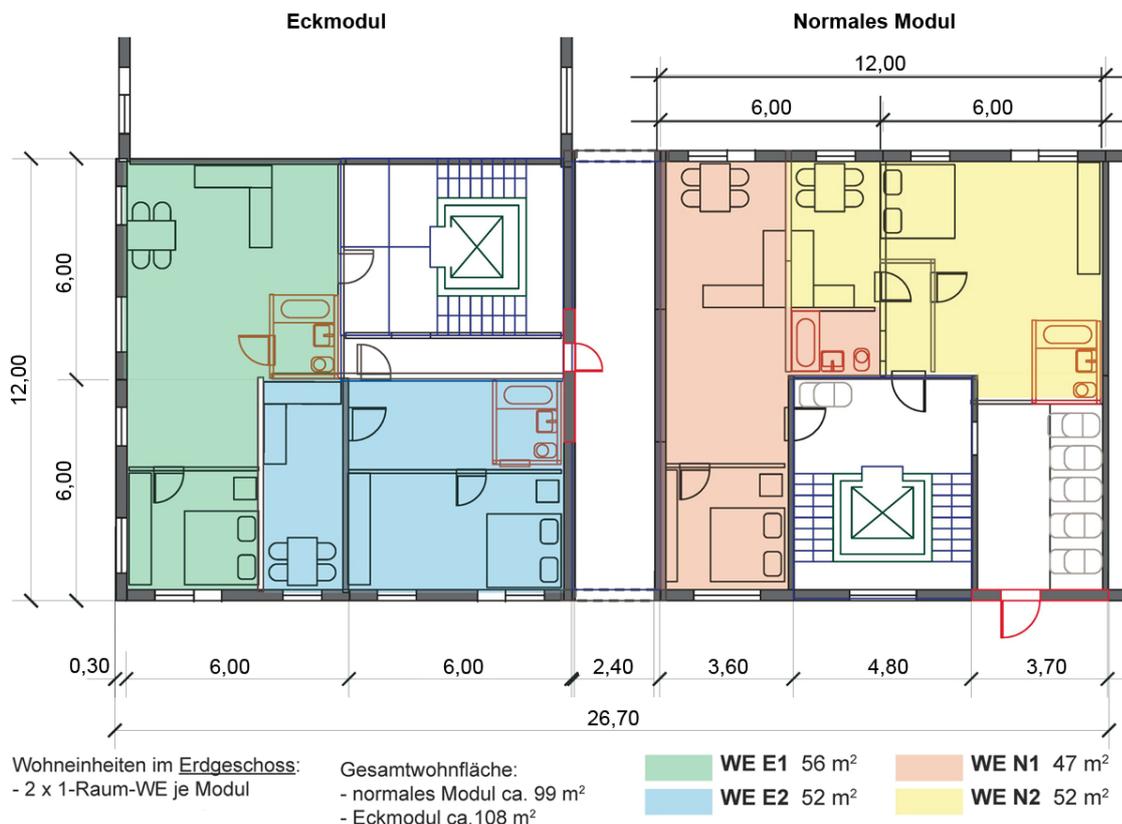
Grundriss Erdgeschoss, Ausschnitt (M 1:200)
